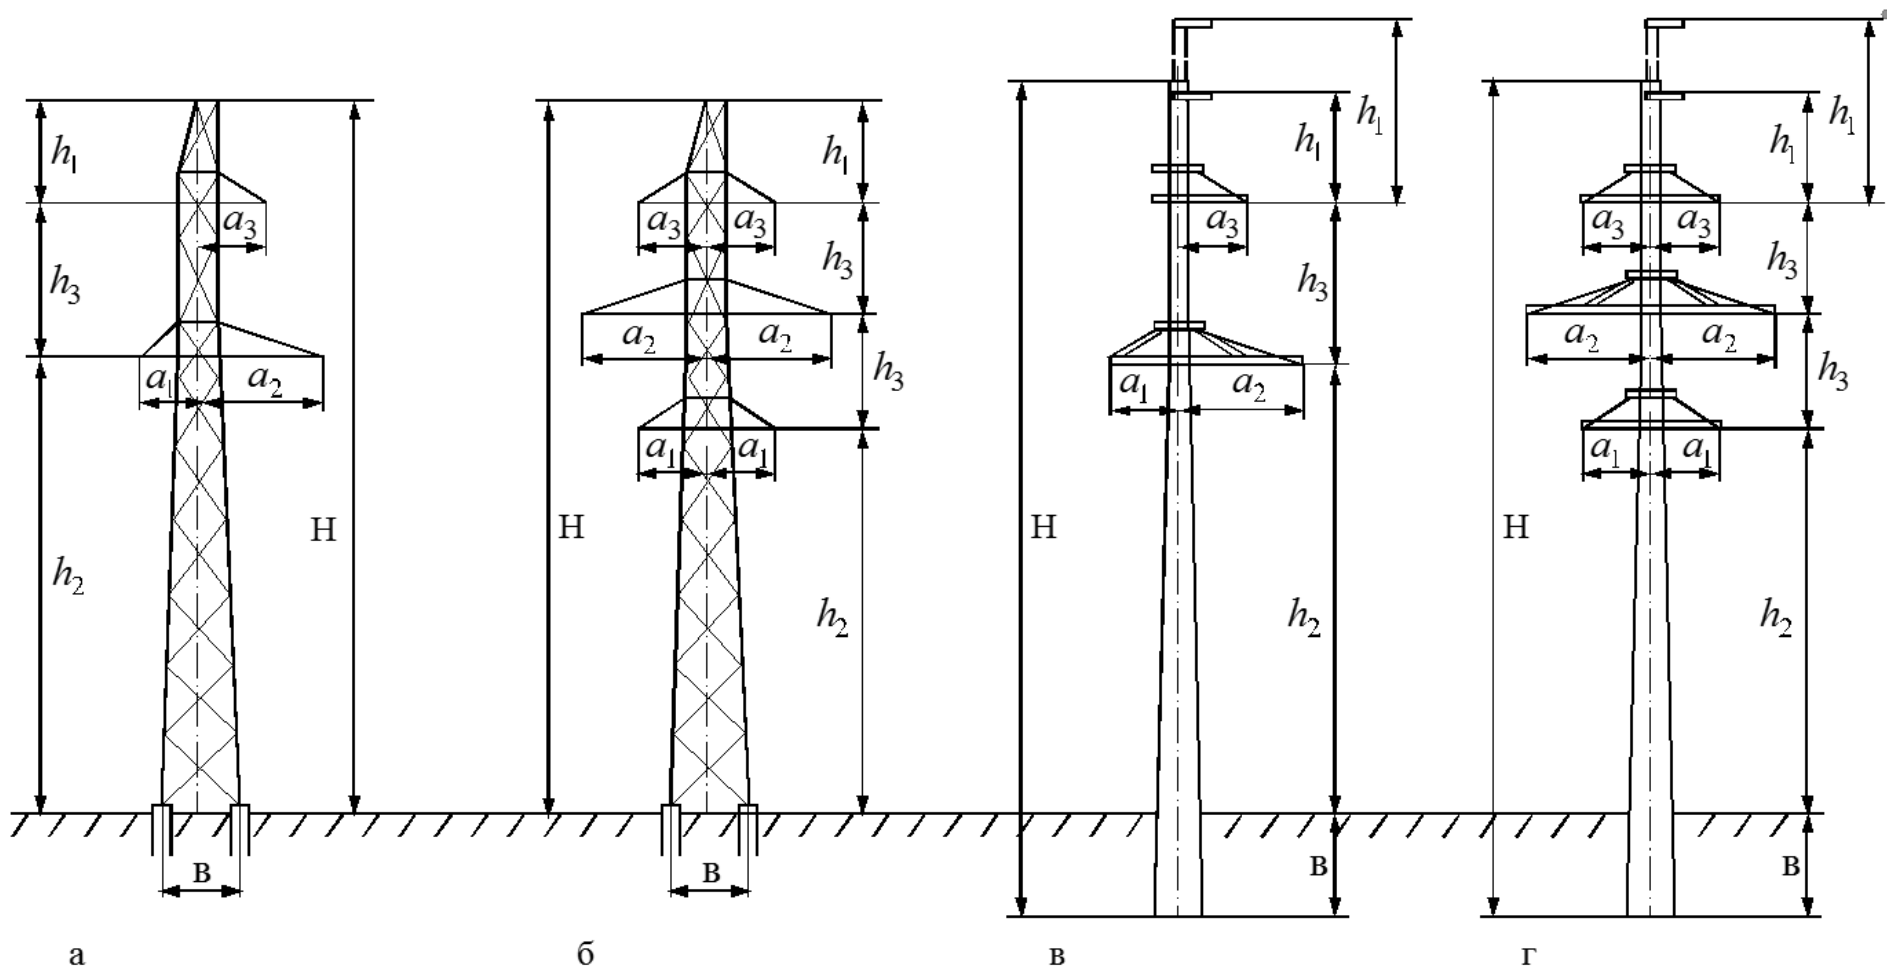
Унифицированные стальные (а, б) и железобетонные и железобетонные (в, г) промежуточные опоры
